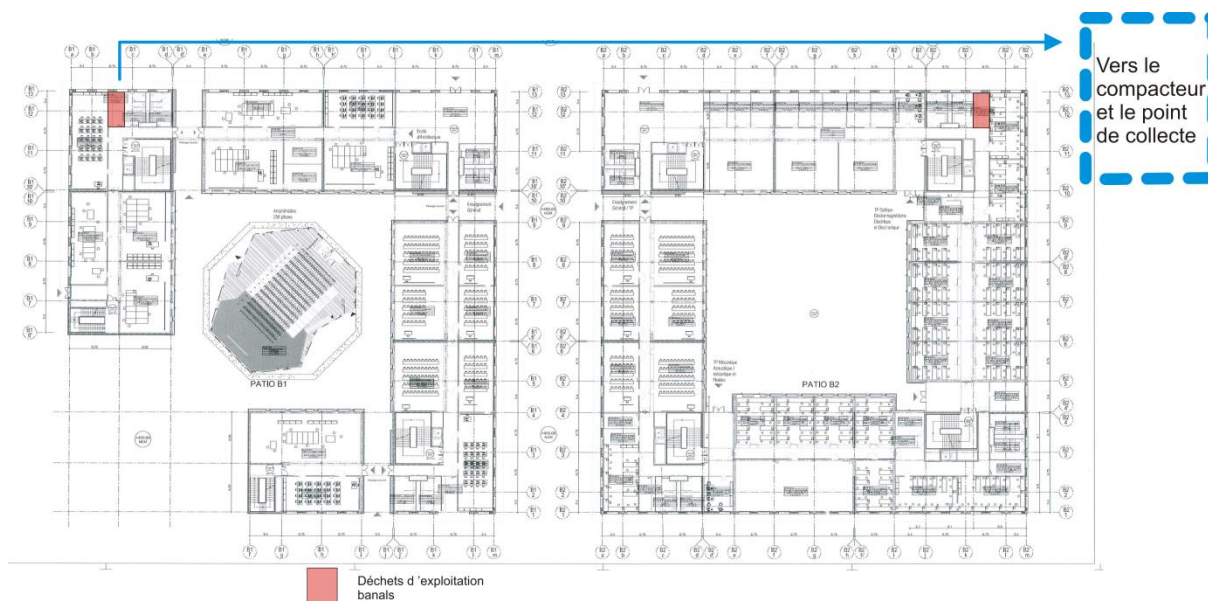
Localisation des locaux déchets sur les plans APD du rez-de-chaussée B1 et B2
